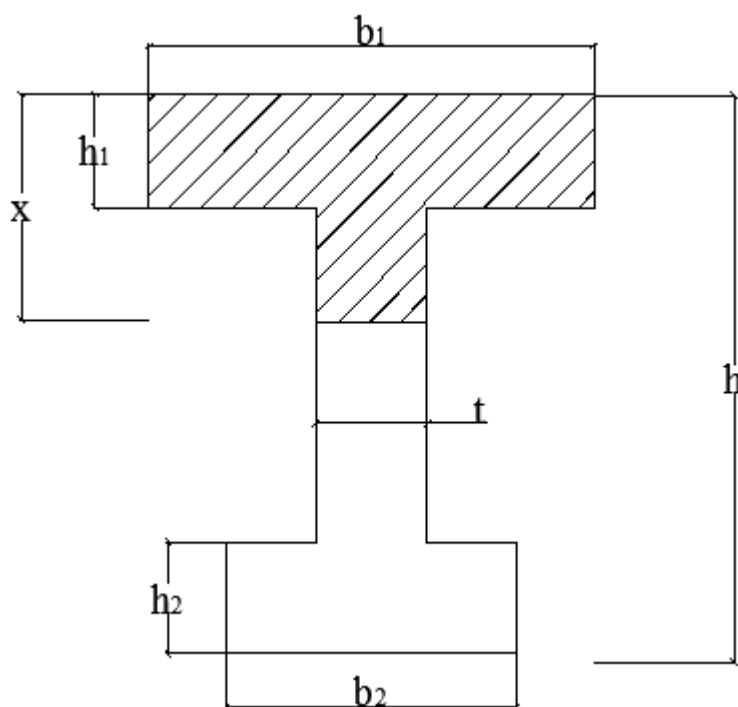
Схема к определению параметров аппроксимации для железобетонного двугаврового сечения с нормальной трещиной
